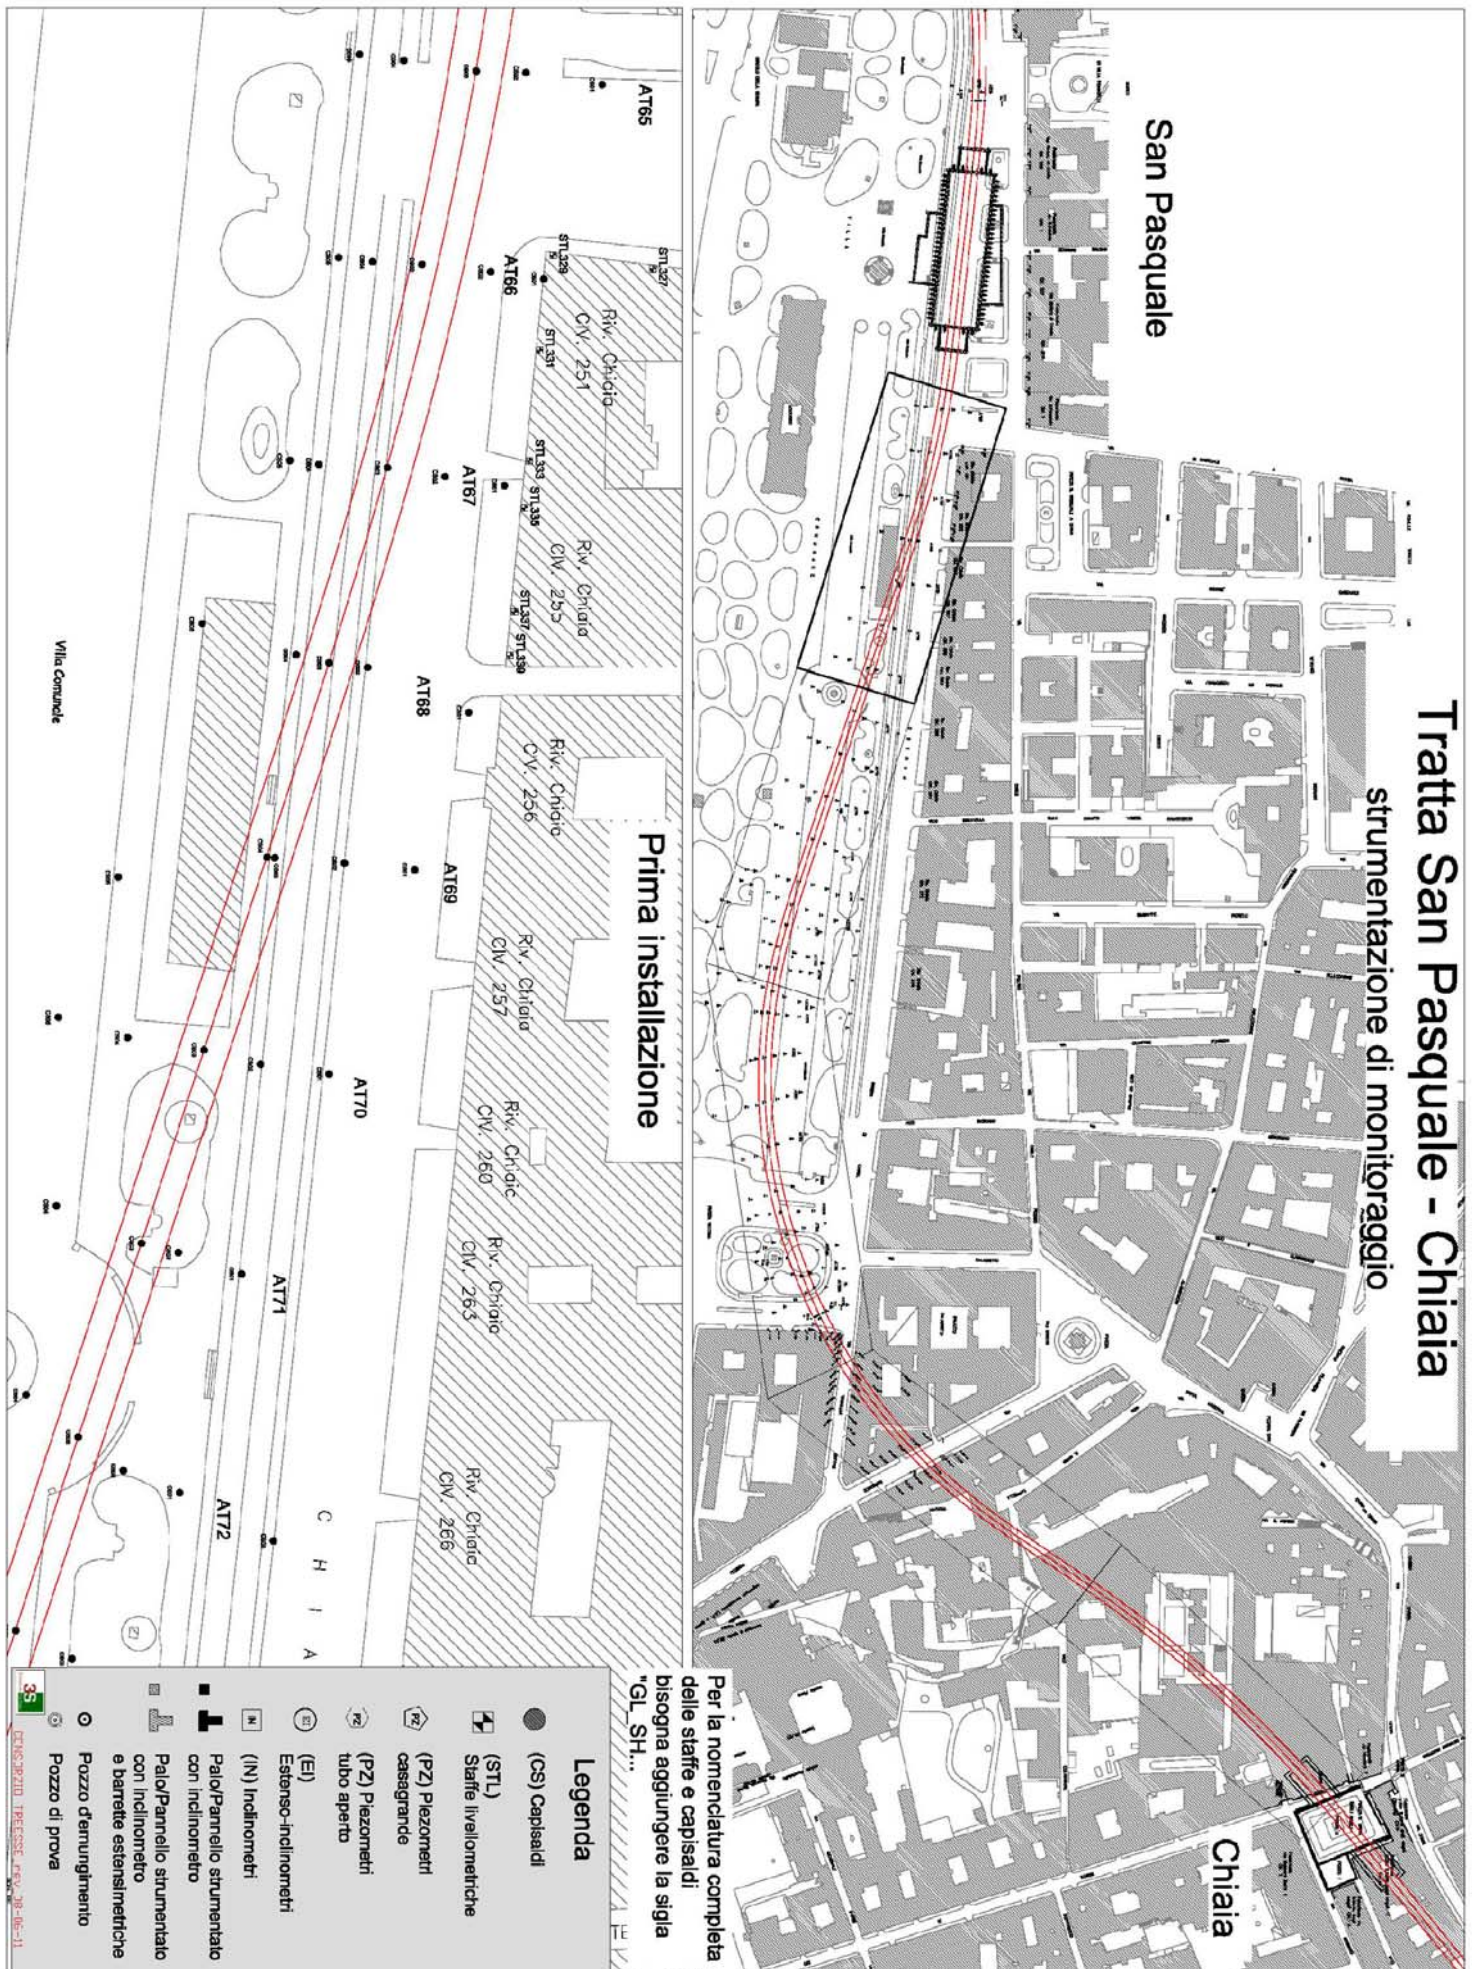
Planimetria tratta San Pasquale - Chiaia, raffigurante la disposizione della prima installazione della strumentazione di monitoraggio.
